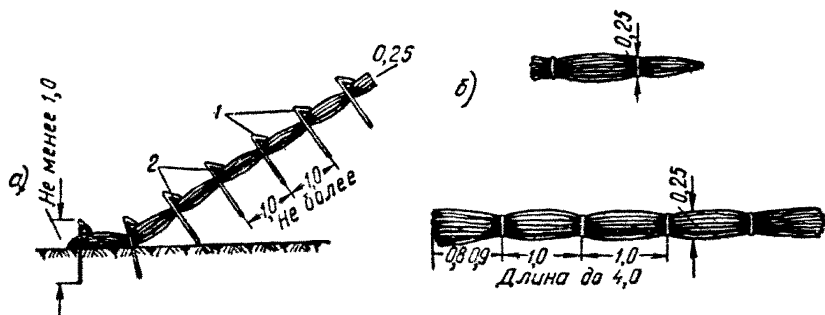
Укрепление откоса насыпи или бермы укладкой fascин плашмя
